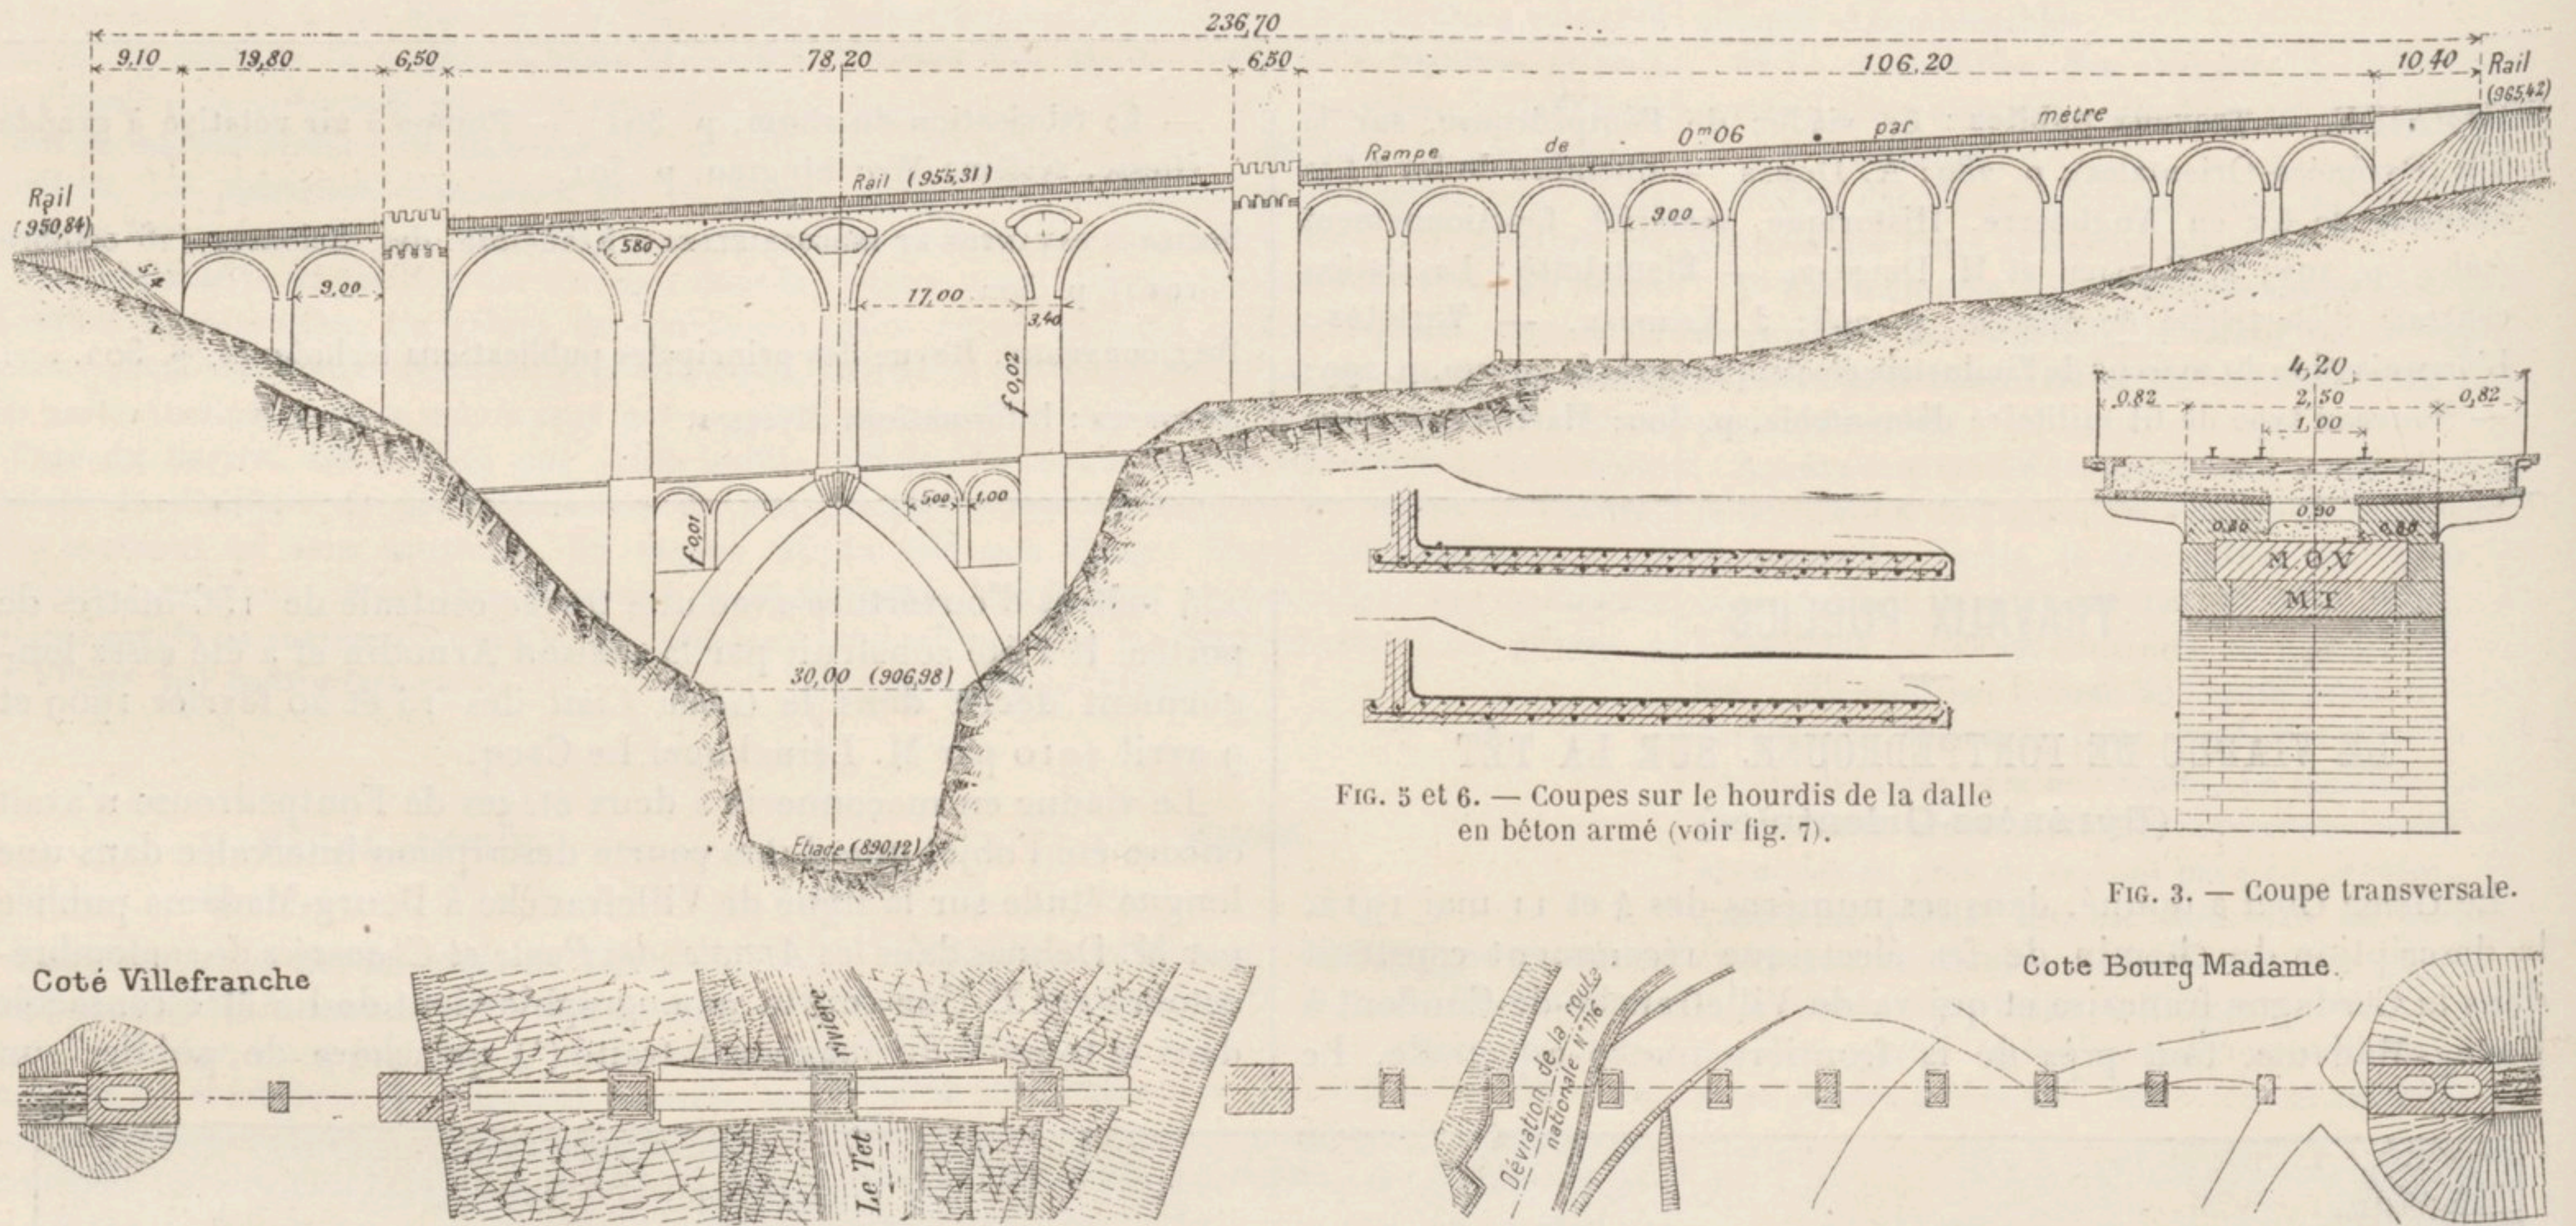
à 6. — Élévation, plan d'implantation et coupe transversale du viaduc de Fontpédrouse.
